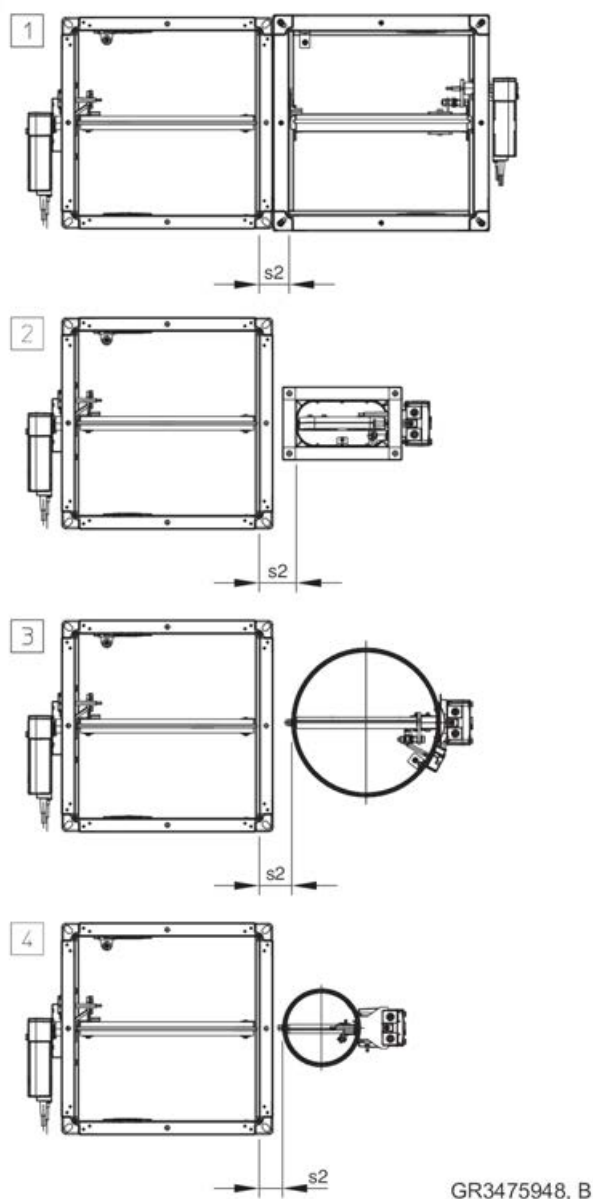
Distance entre FK2-EU et d'autres clapets coupe-feu TROX dans une installation au mortier
